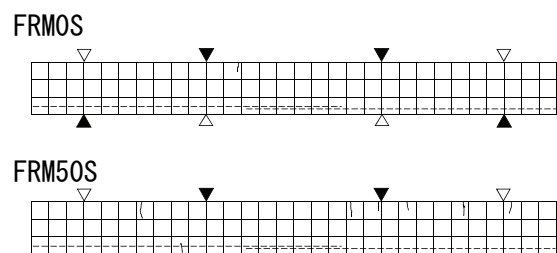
a) 乾燥収縮ひび割れ(側面、1 年時)
